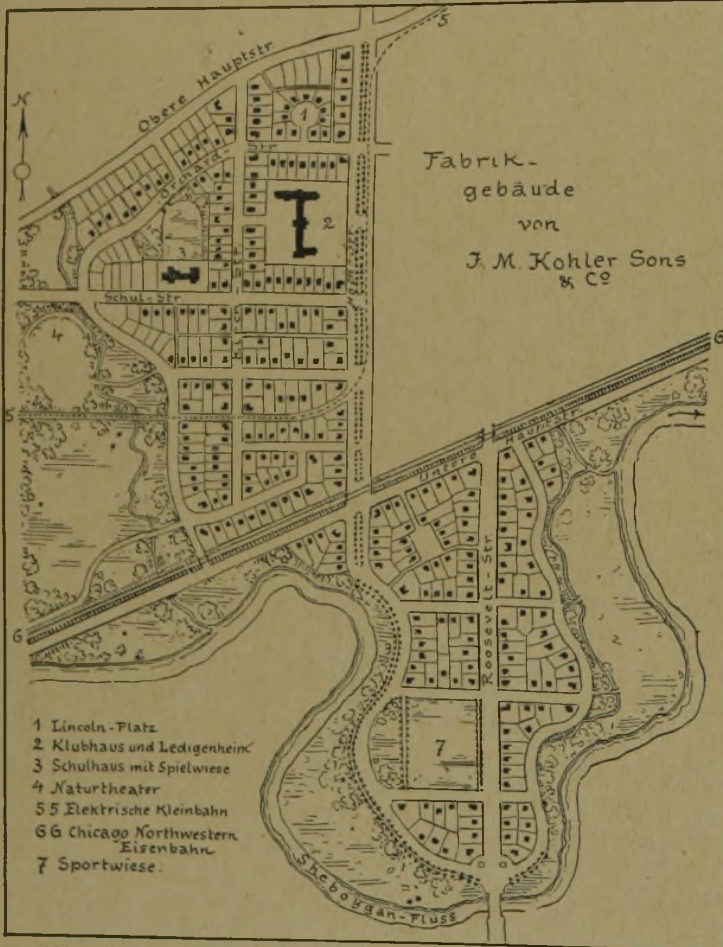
Lageplan des Dorfes Kohler bei Milwaukee im Staate Wiskonsin.
